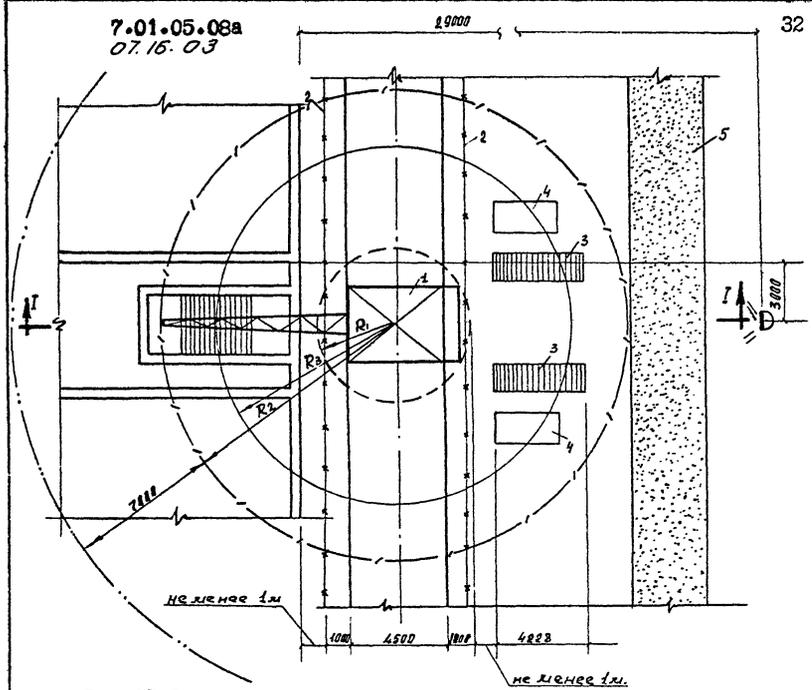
Схема складирования и монтажа лестничных маршей и площадок башенным краном.
